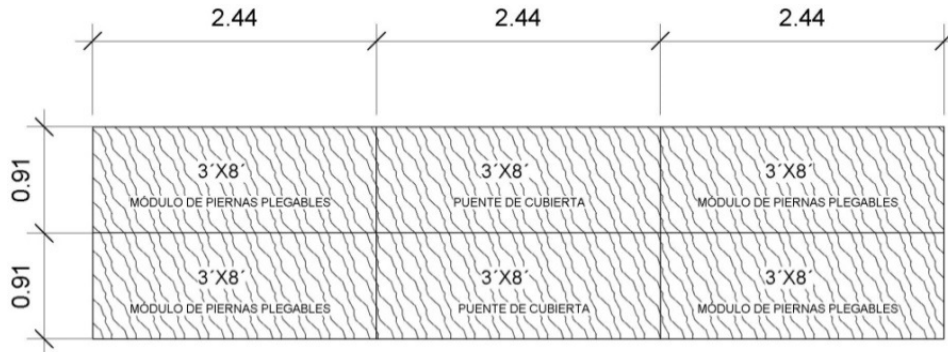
CONFIGURACIÓN TÍPICA DE MODULADO Y PUENTEO PARA ENTARIMADO DE 3' X 8'
